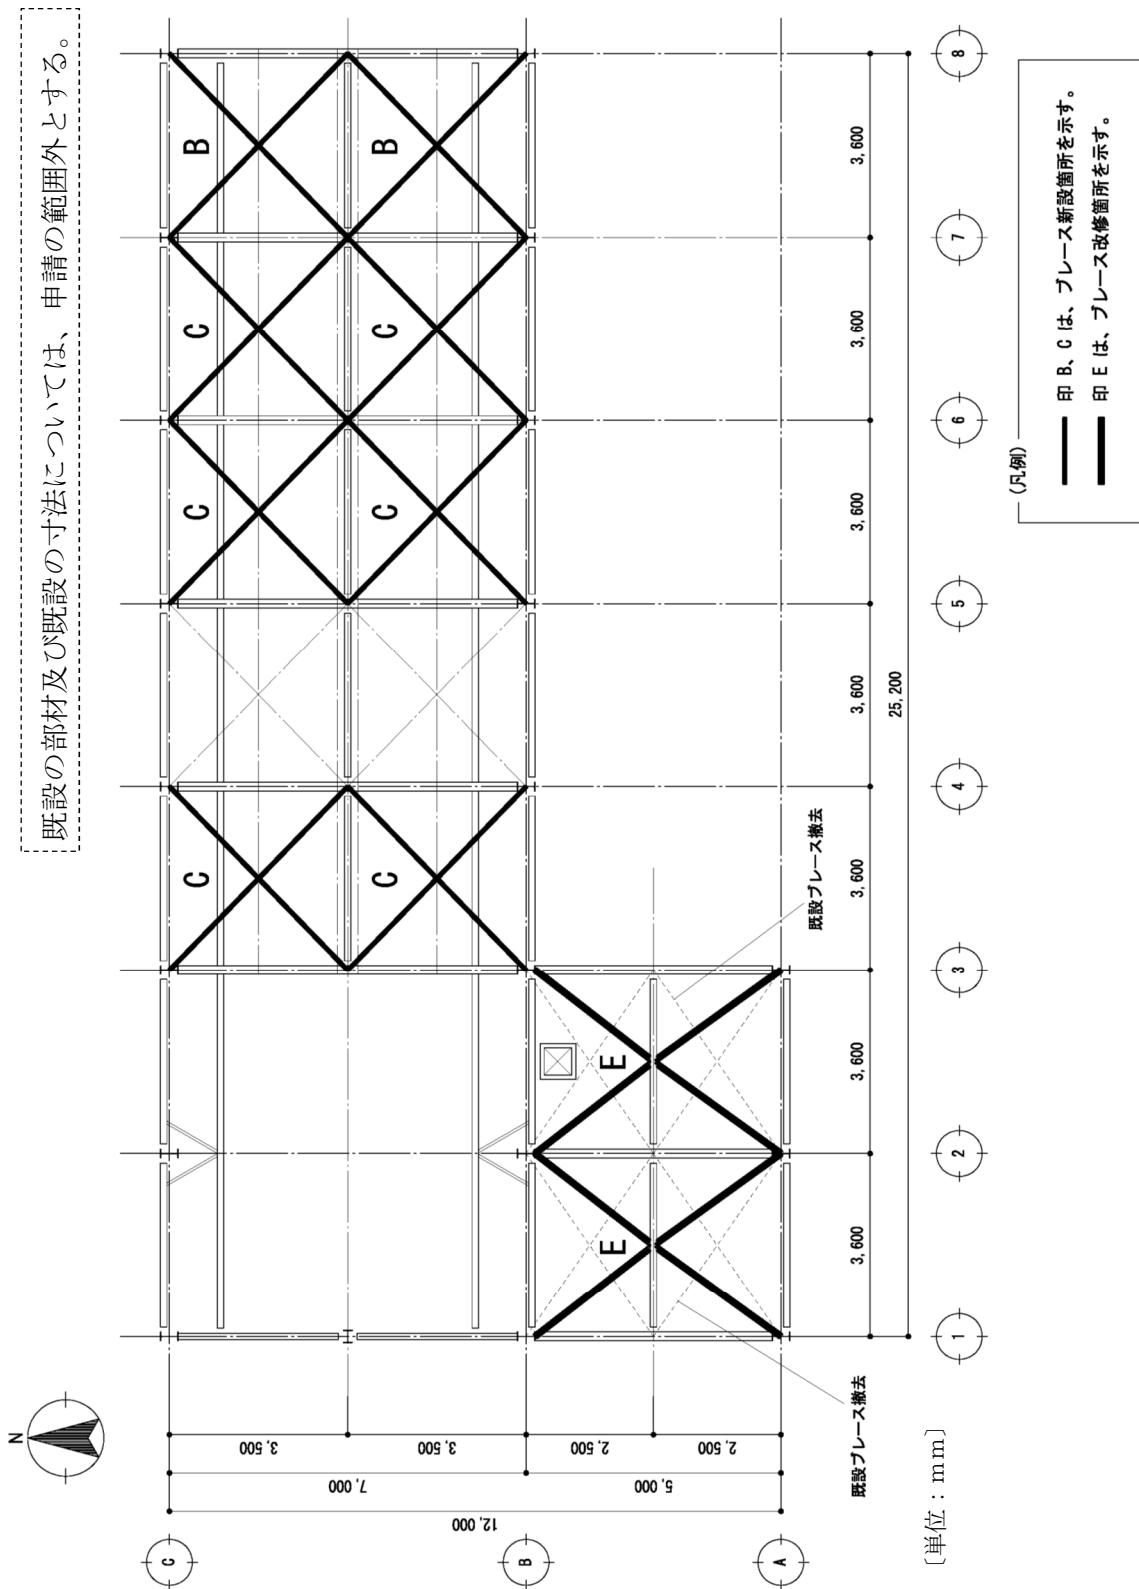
燃料棟 屋根伏図 (R2 レベル)
